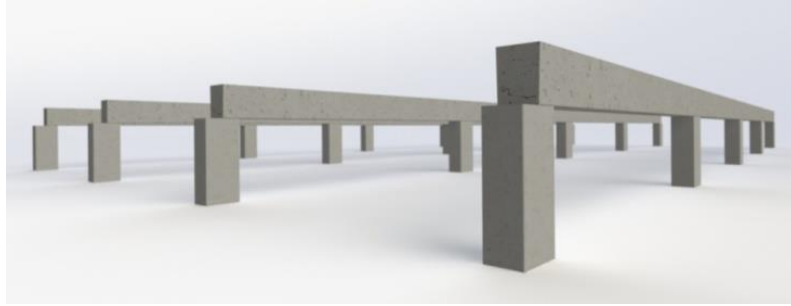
Pilars i jàsseres de formigó armat prefabricat
